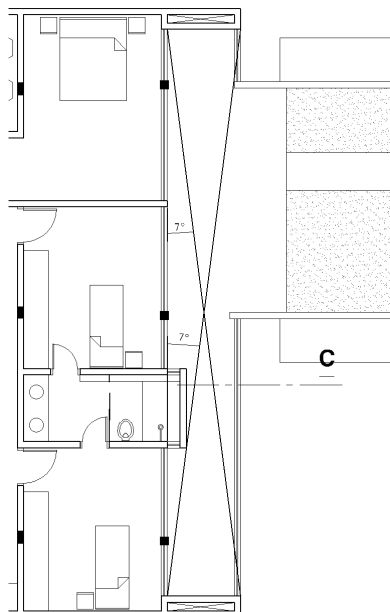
Projeto 1 - Planta – ângulo de proteção do elemento Vertical na Fachada Norte
